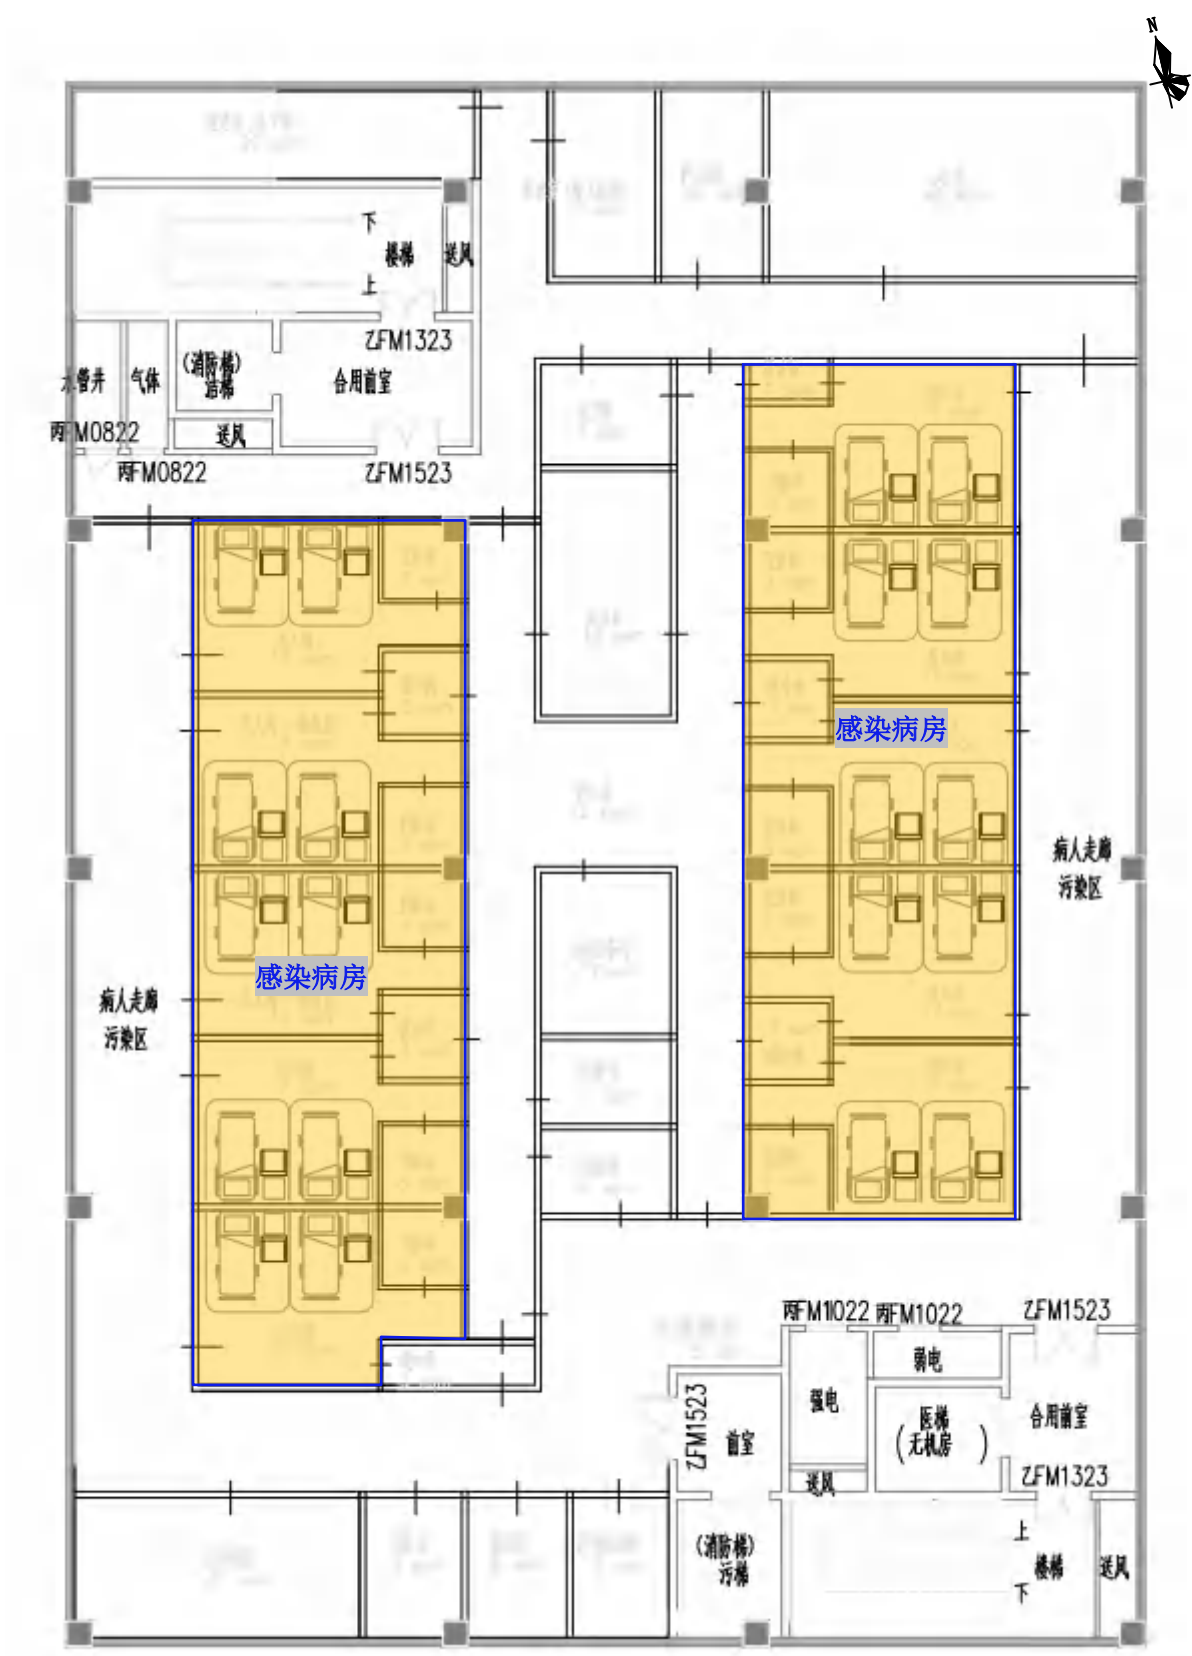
项目感染科楼三层平面布置图（比例尺：1:201）
